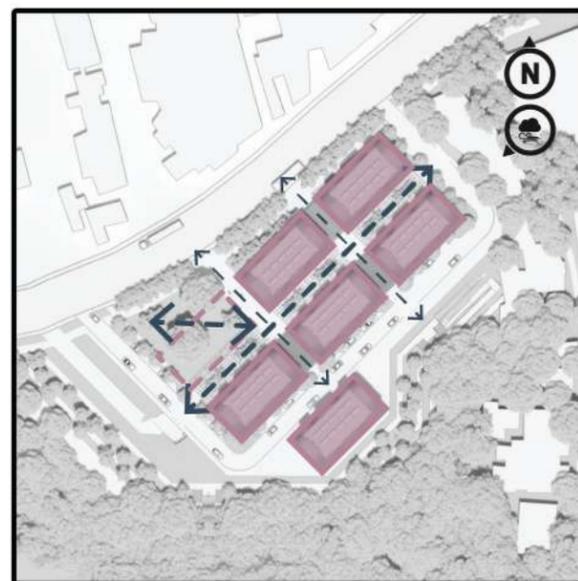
Planta de sitio de Las Orquídeas. Fuente: propia.
